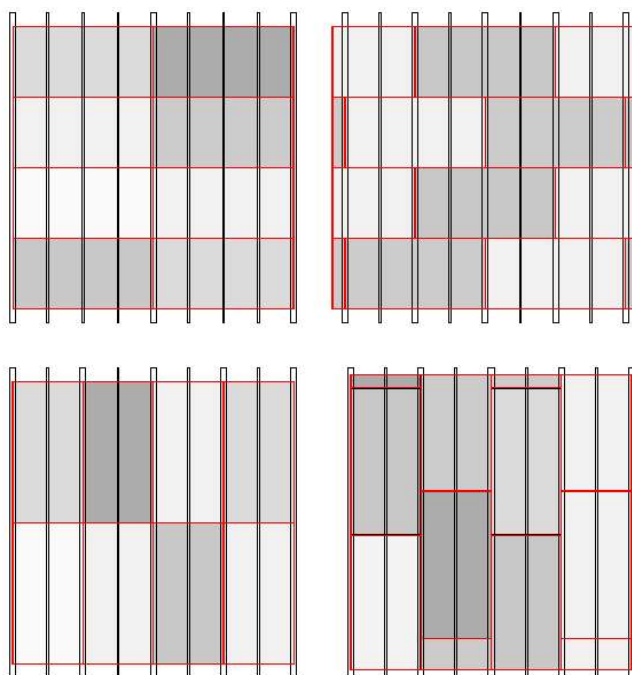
Esempi di layout a giunti continui e a giunti sfalsati, rispettivamente su layout con lastre orizzontali e con lastre verticali.
